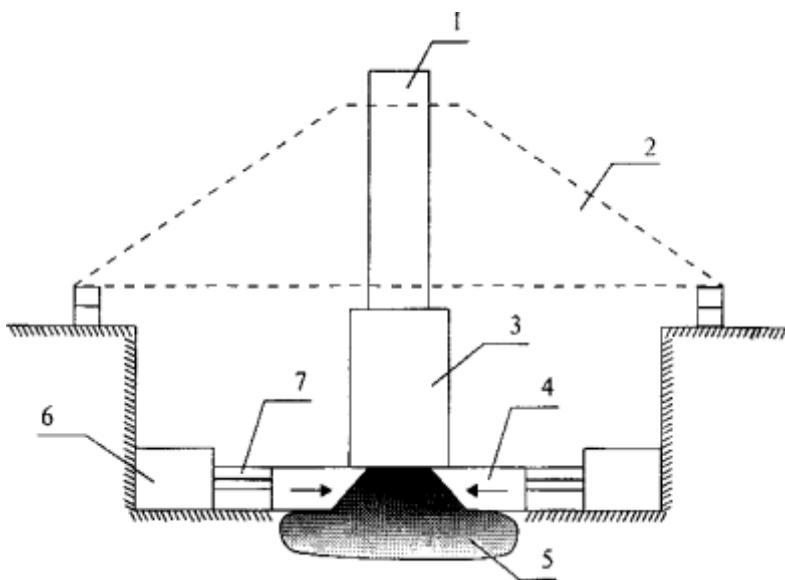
Усиление фундамента с обжатием основания элементами уширения:
